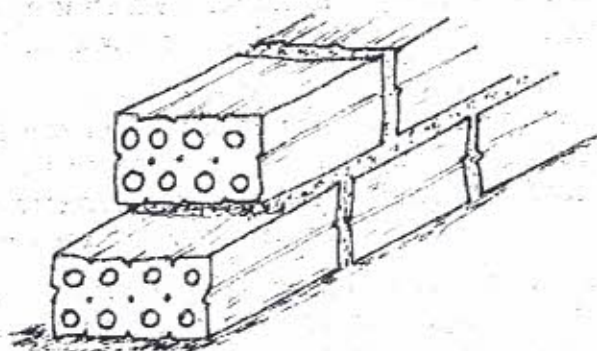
Execução de alvenaria de 1 vez, utilizando tijolos furados.
